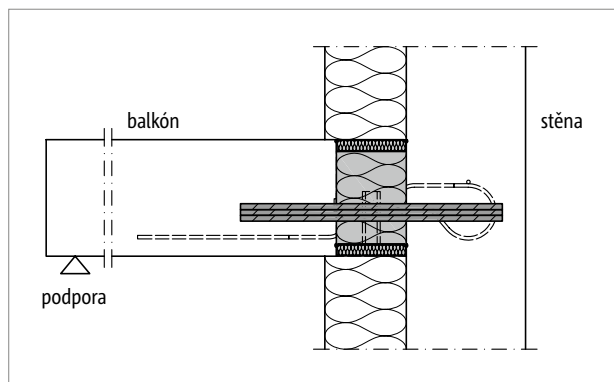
Schöck Isokorb® XT typ HP: Volně vyložený balkón
